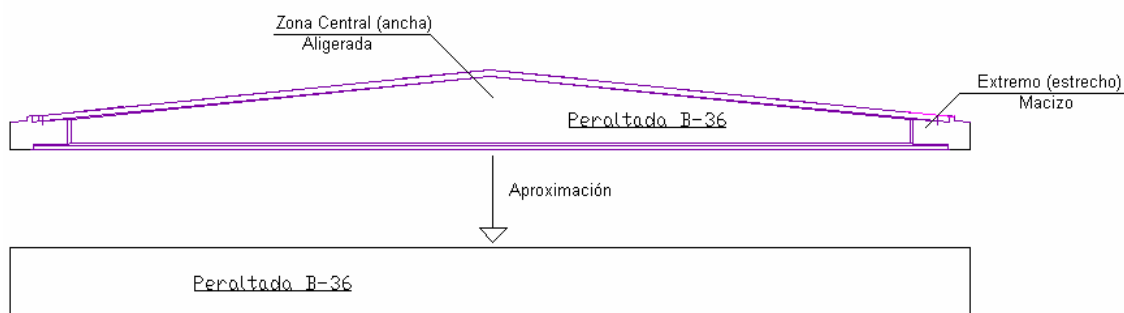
Aproximación en el cálculo de la jácena de cubierta “B-36”
